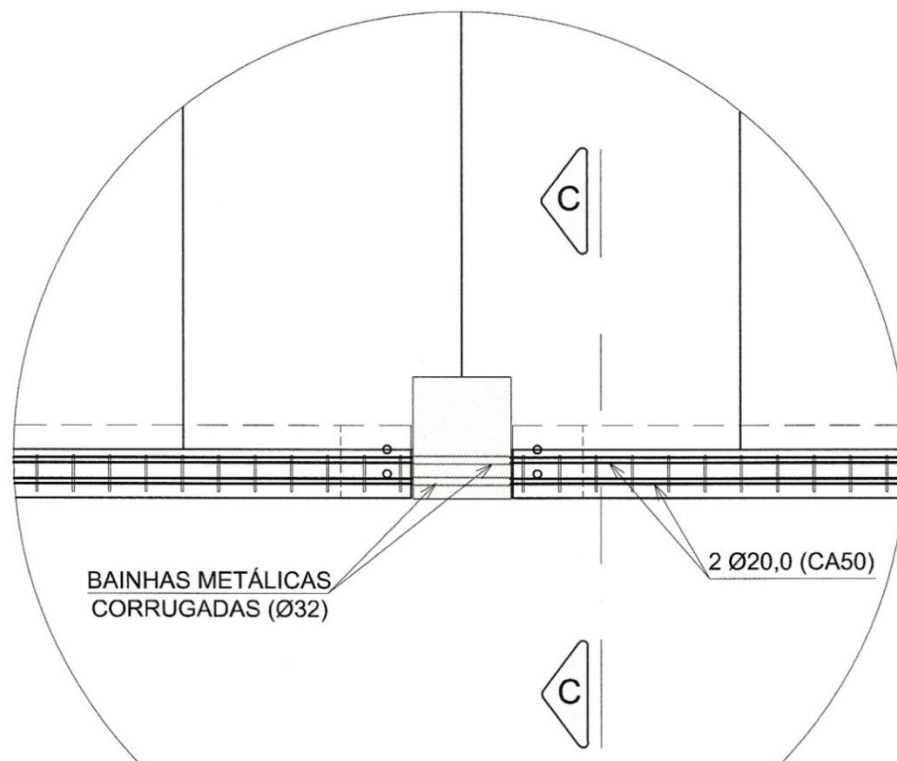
17 – Interferência das barras do tirante com pilares intermediários da estrutura.
